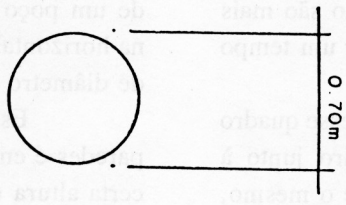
Corte Horizontal de um Poço Típico da Construção Civil Paulistana.
